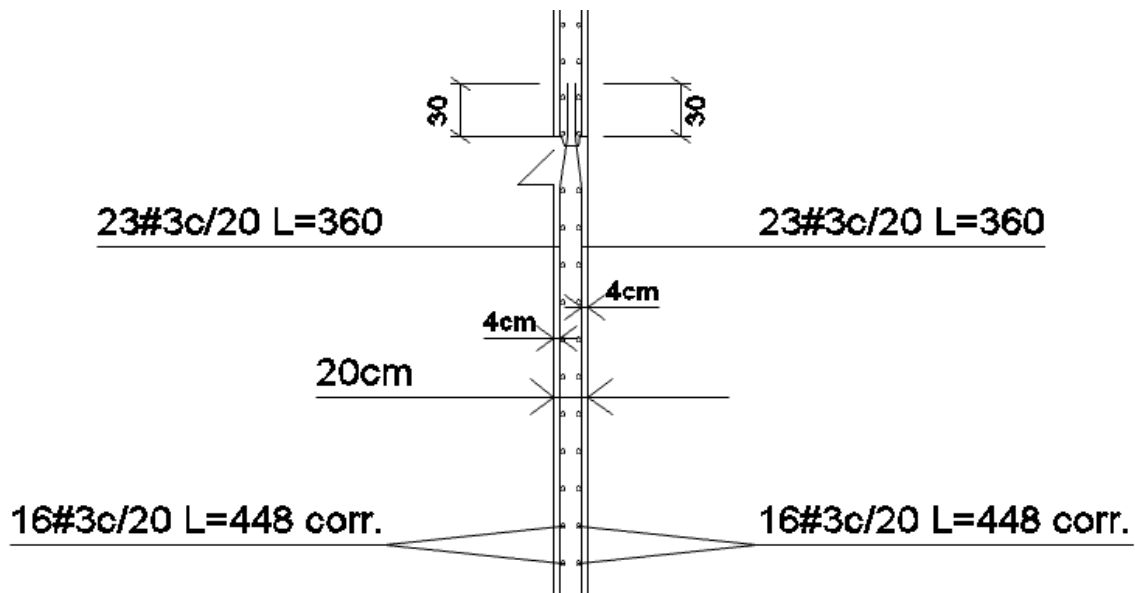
Plano de aceros de refuerzo para pantallas. Fuente. Ingeniera. Alexandra Correa
